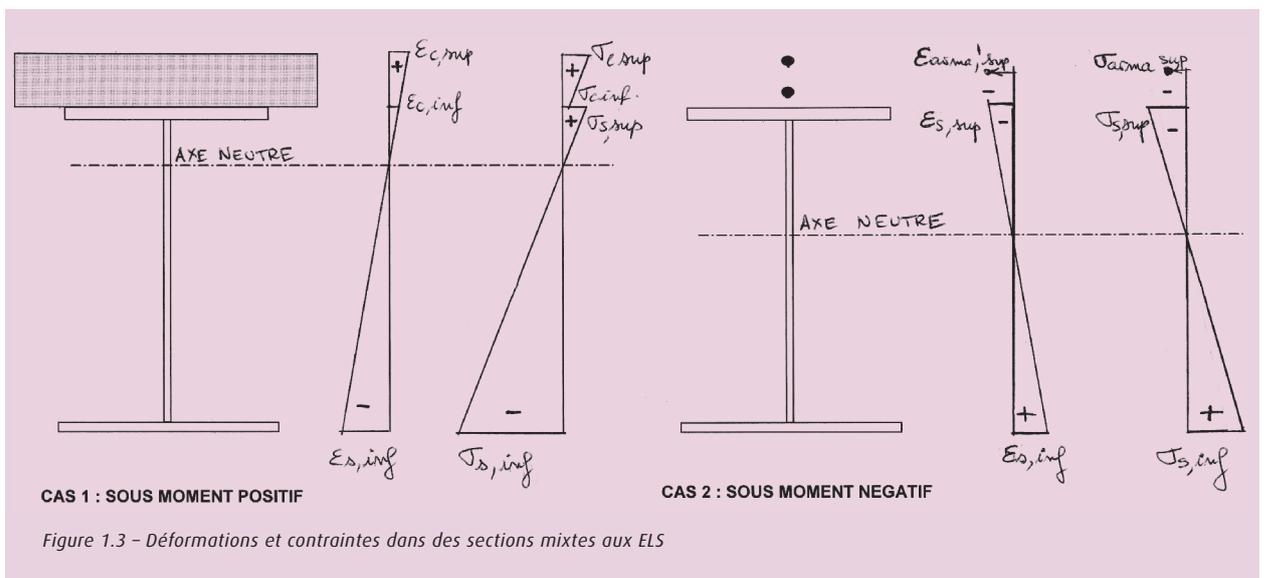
Déformations et contraintes dans des sections mixtes aux ELS
